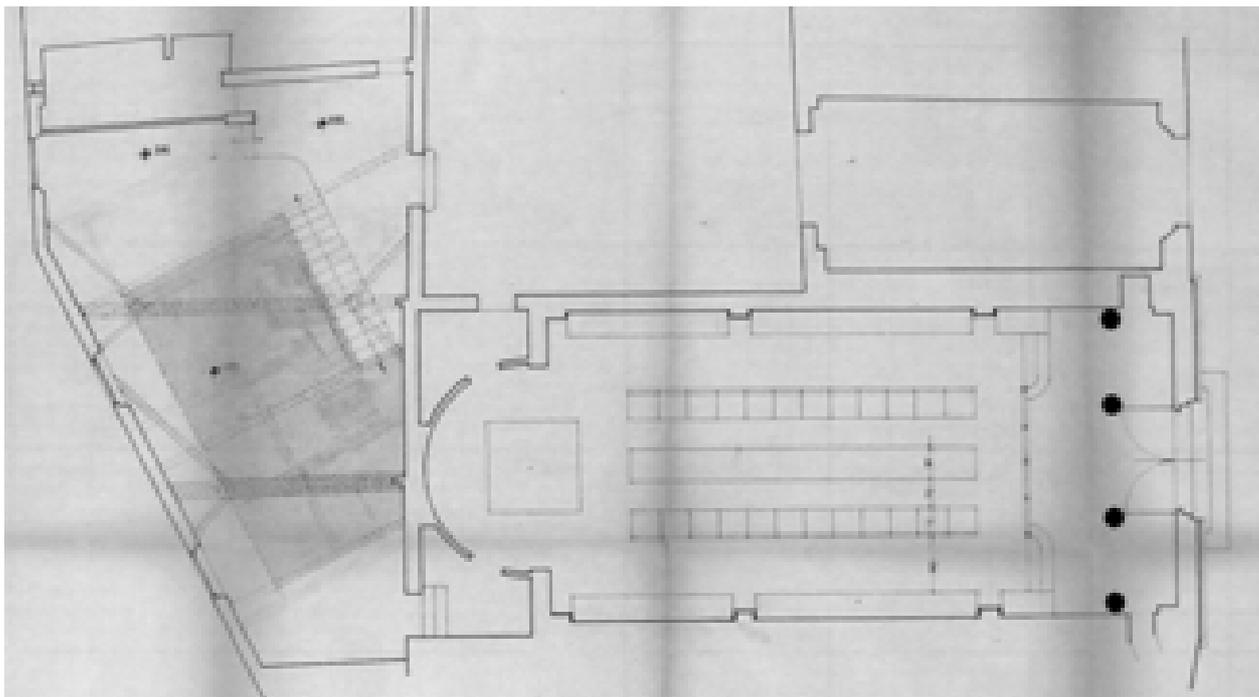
San Leonardo, pianta +0,00 – stato futuro - s.d. (AABS-94.057)
